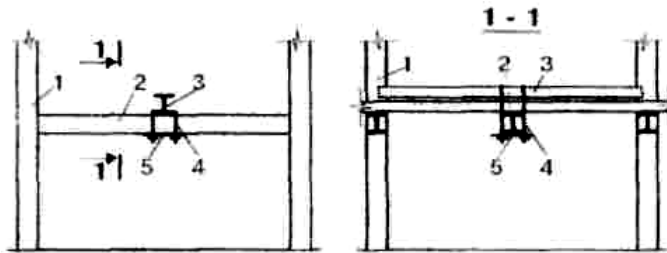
Схема виробництва робіт по підсиленню металевих балок шляхом передачі навантаження на інші конструкції:
